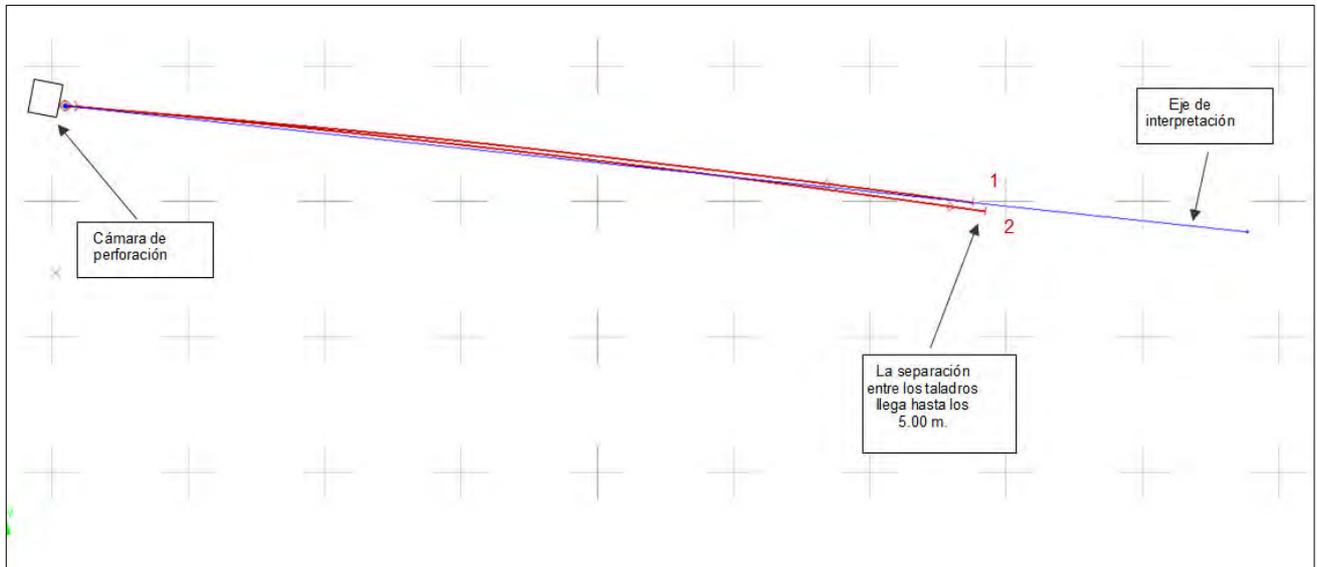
Vista en planta de dos taladros de perforación ejecutado. Elaboración propia.
